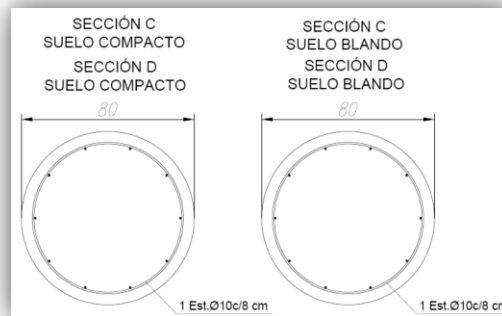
Detalle armadura estribo zunchado pilote, sección C y D
